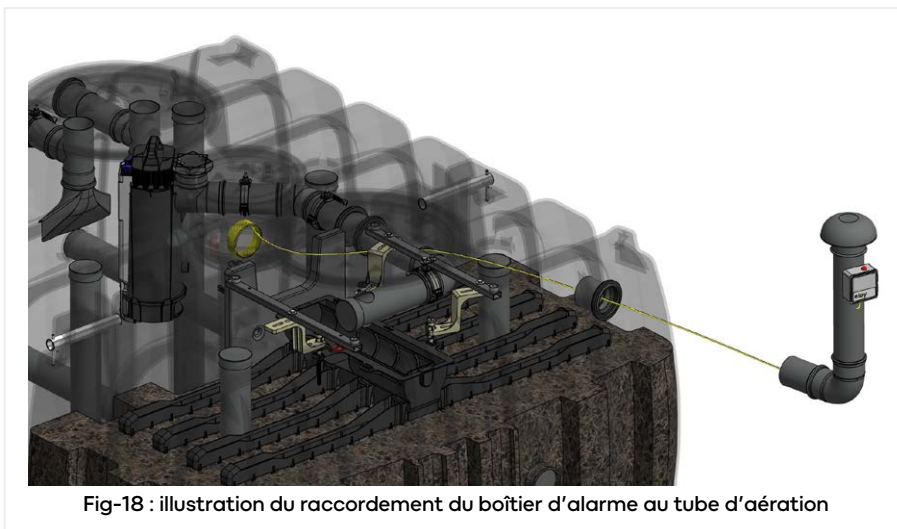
illustration du raccordement du boîtier d'alarme au tube d'aération
